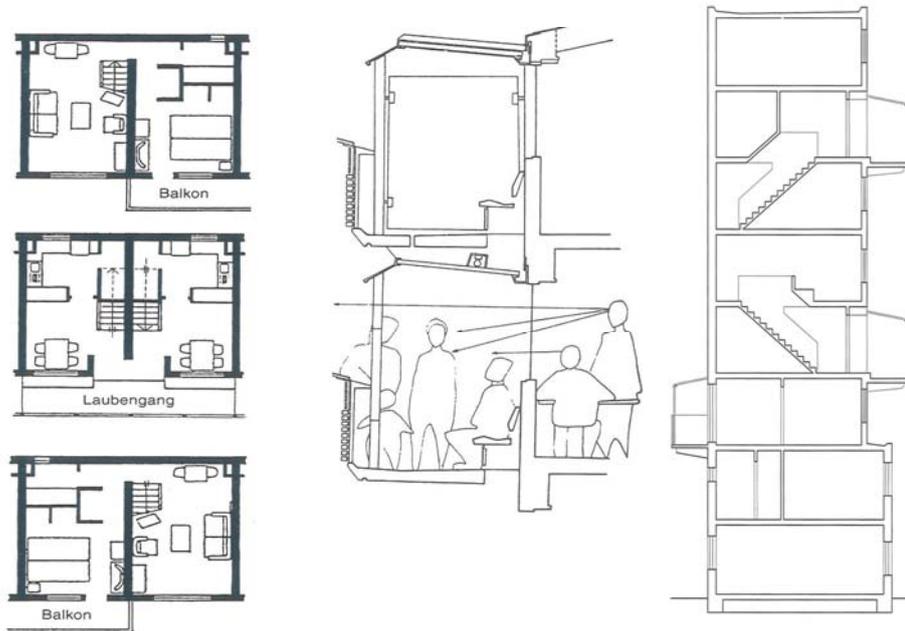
Maisonnettegrundriss nach oben oder unten (l)
